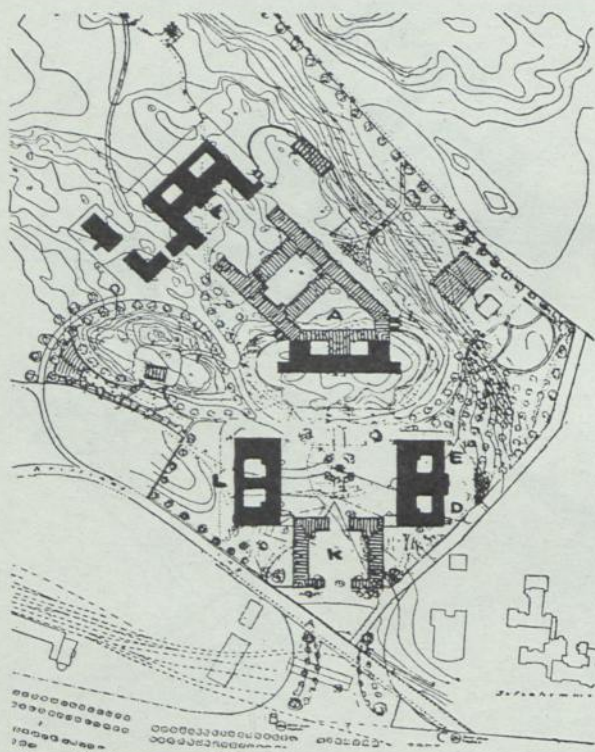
FÖRSLAGET N:R 8: SITUATIONSPLAN.
